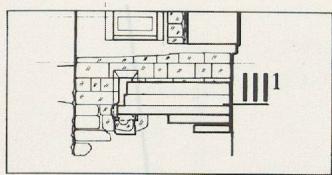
Cour haute, la façade nord avec l'escalier III¹ (éch. 1:150).
